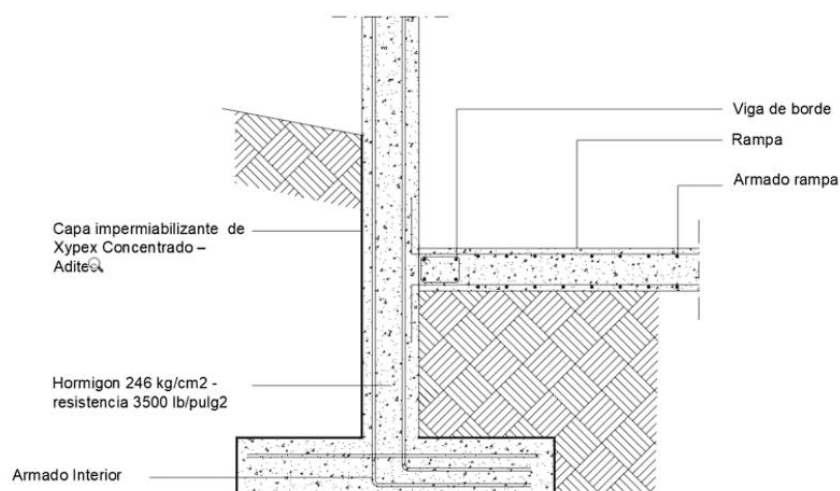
Detalle constructivo Unión de la rampa con el muro de contención
